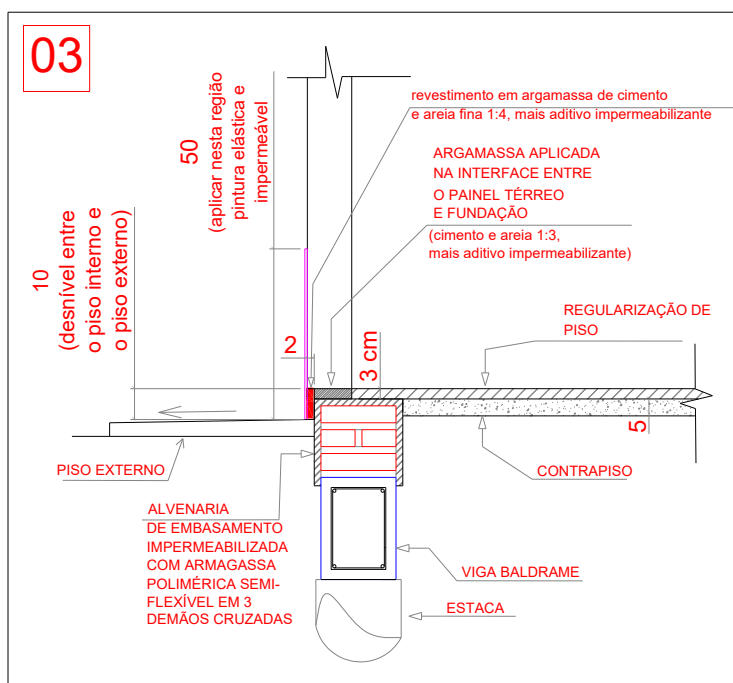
Esquema de impermeabilização entre painel térreo e fundação
